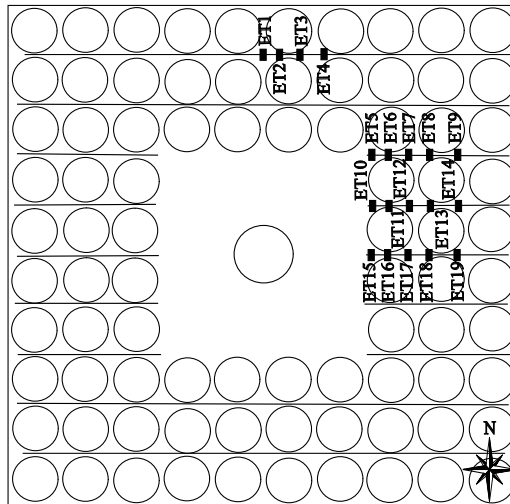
Localização dos extensômetros nas treliças da laje BD-A04
